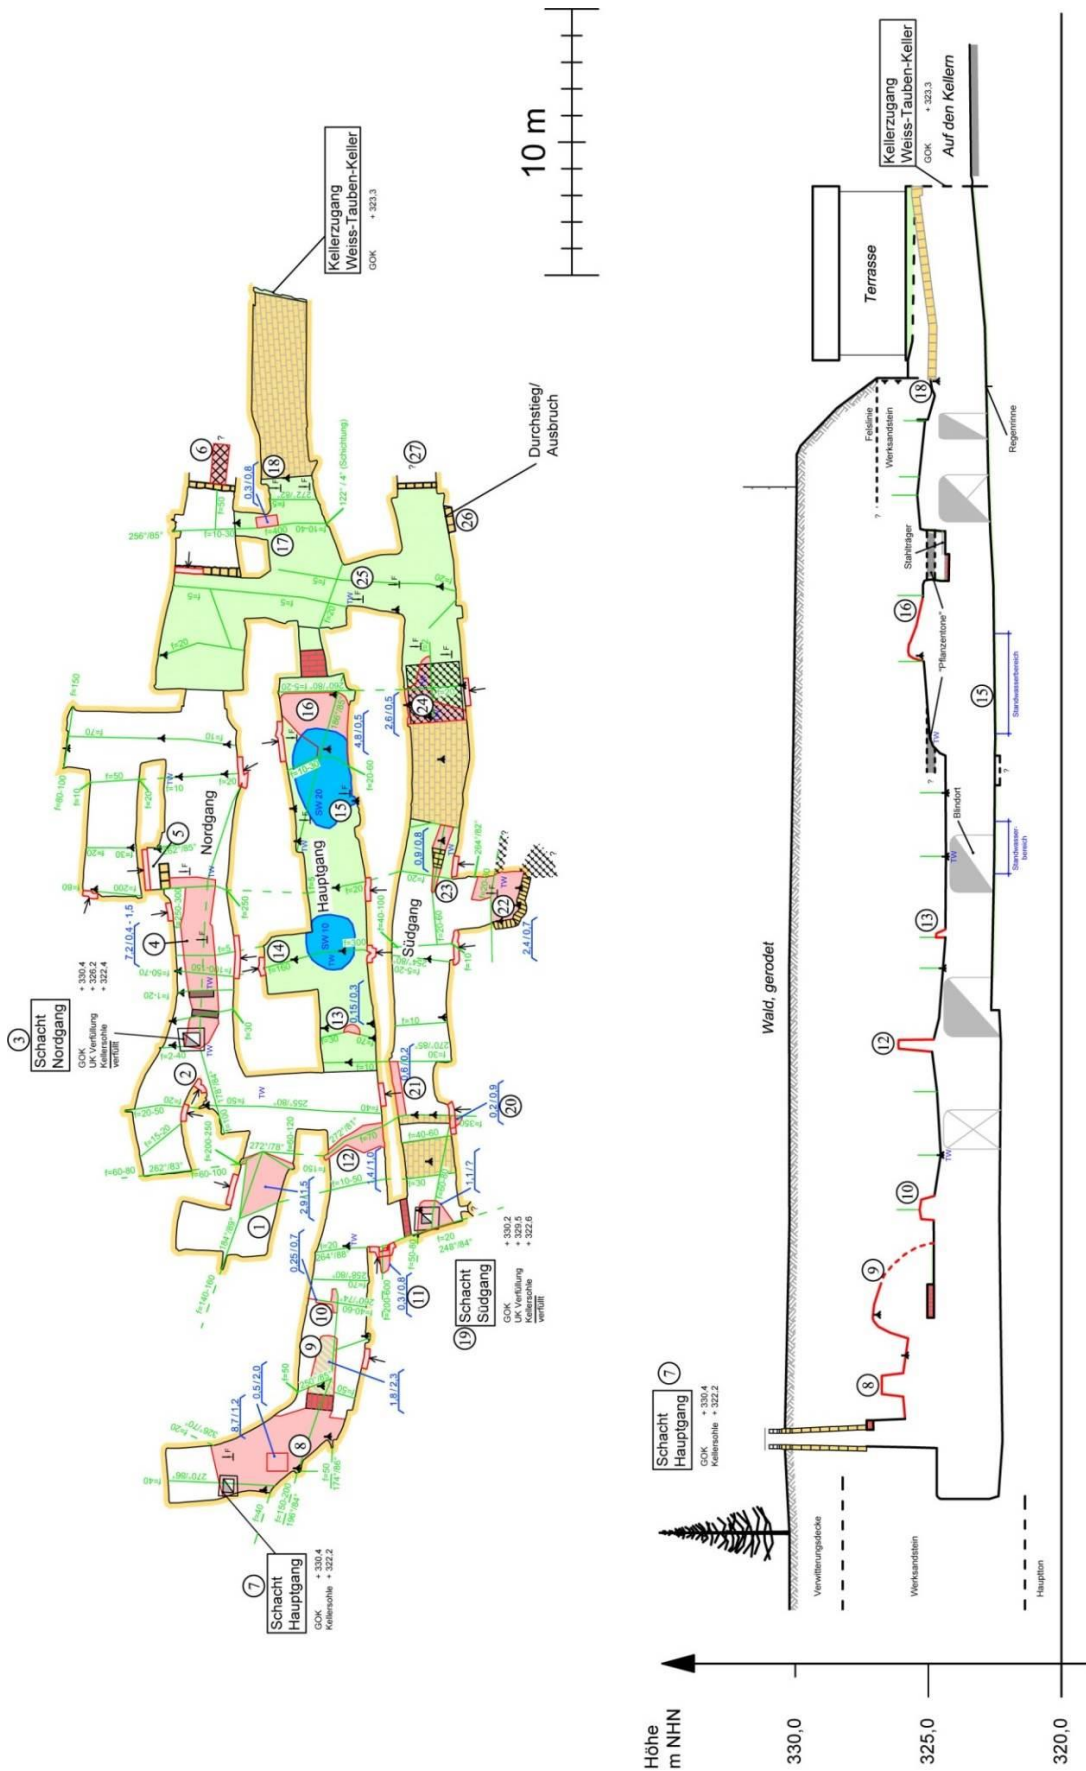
Grundriss der Kellergänge und Schnitt durch den Hauptgang
